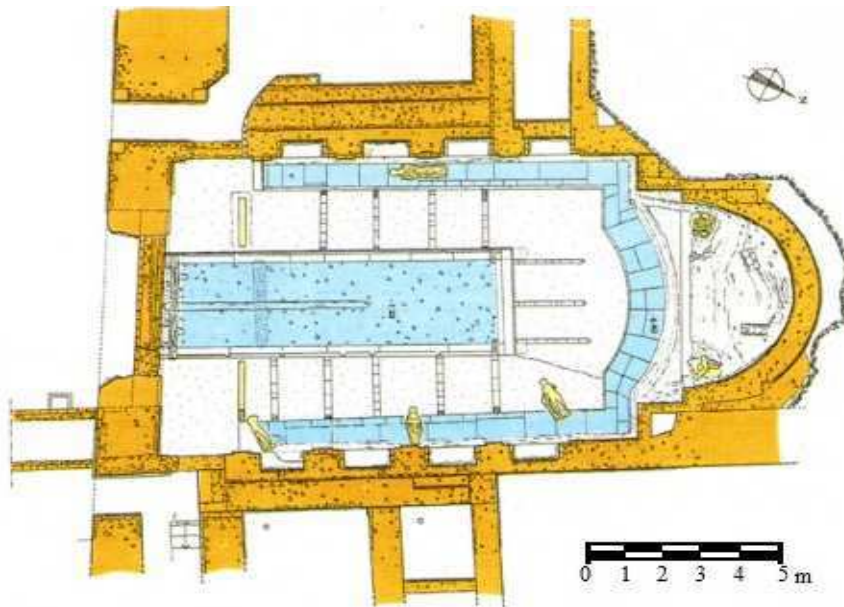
Planimetria del Ninfeo di Punta Epitaffio.
